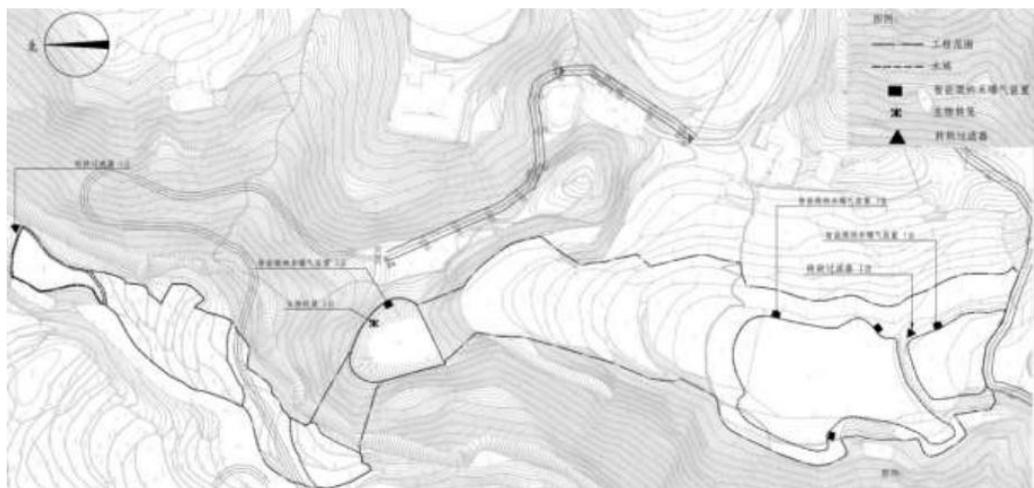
张家河沟下游主要径流通道辅助设备设施平面布置图
